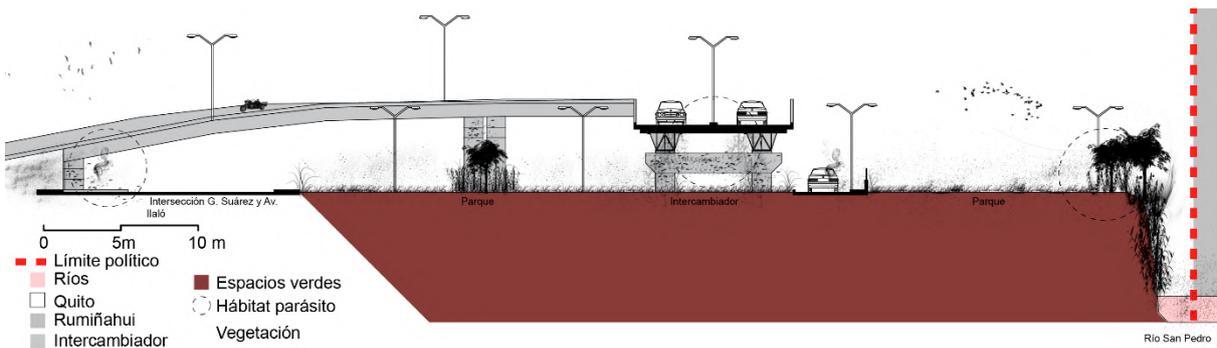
Sección longitudinal 2, zoom 1. Elaboración autor.
